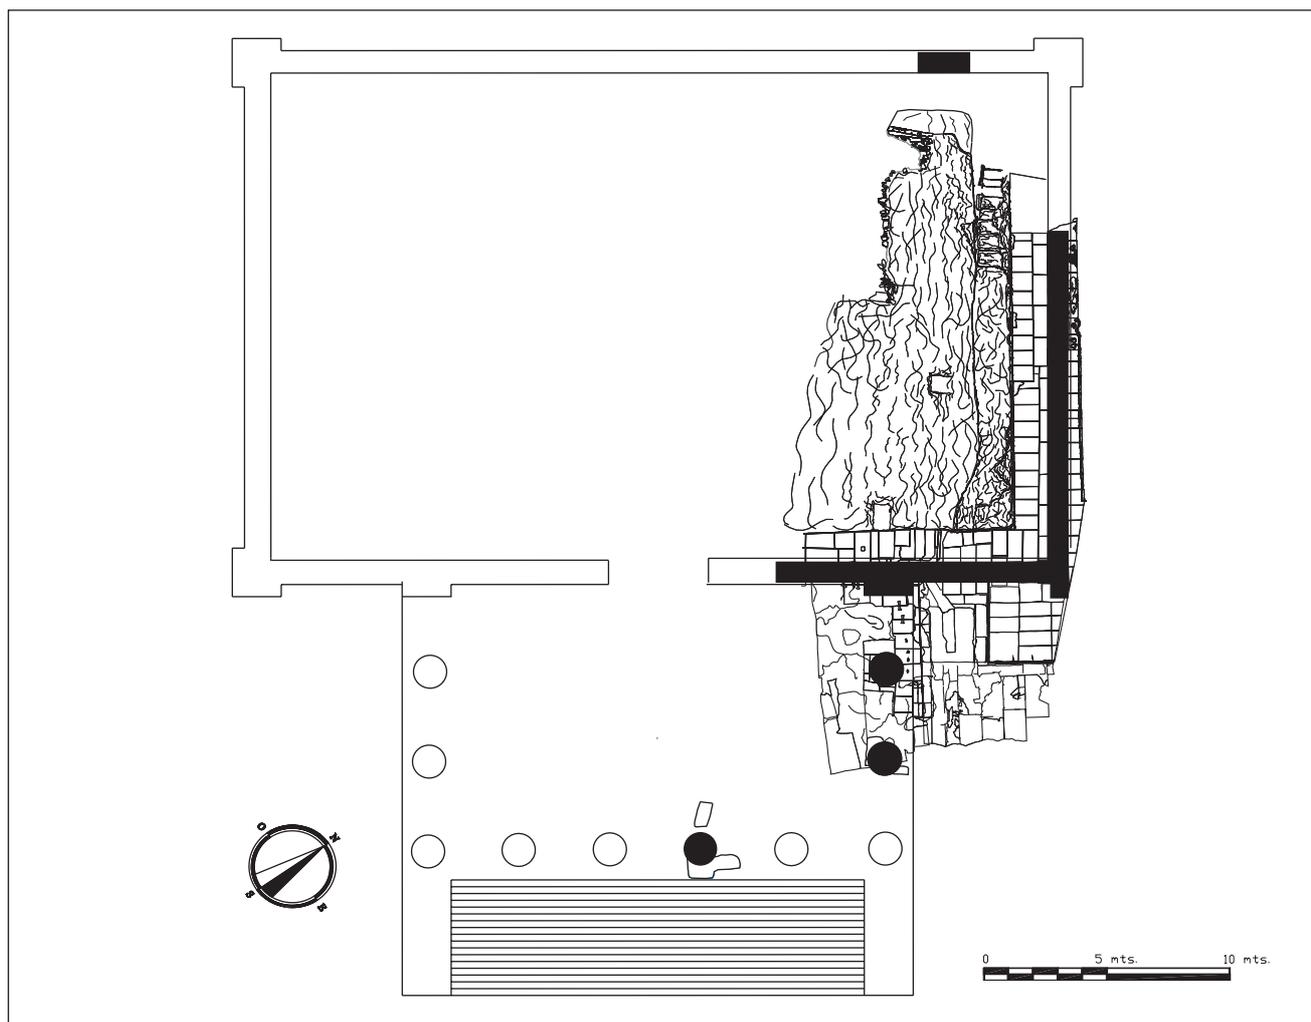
Reconstrucción hipotética de la planta arquitectónica del templo (según el autor).
